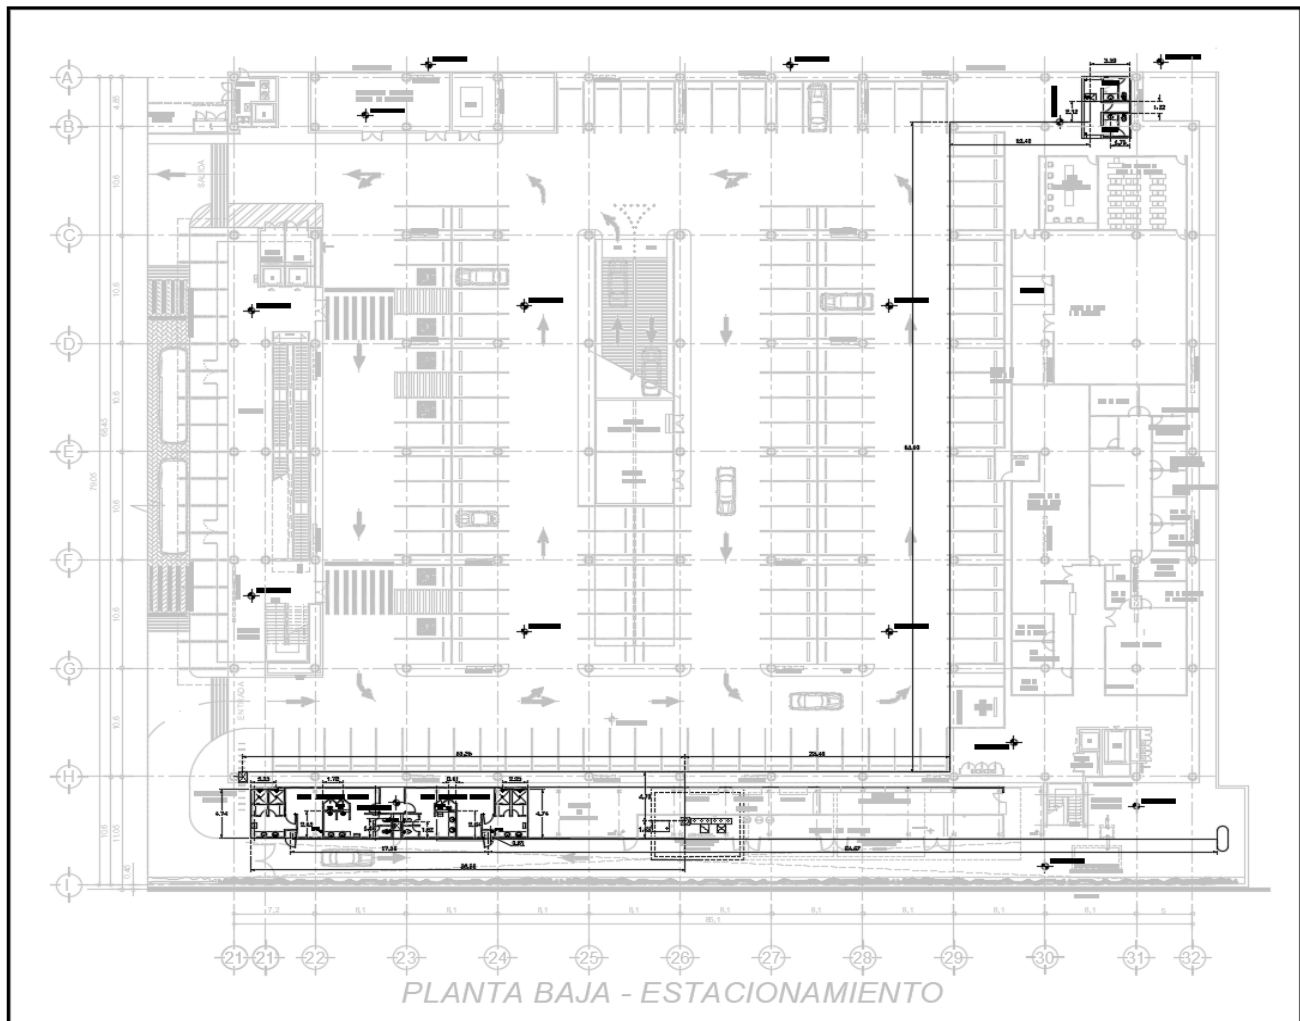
Centro Educativo, planta baja (estacionamiento)
